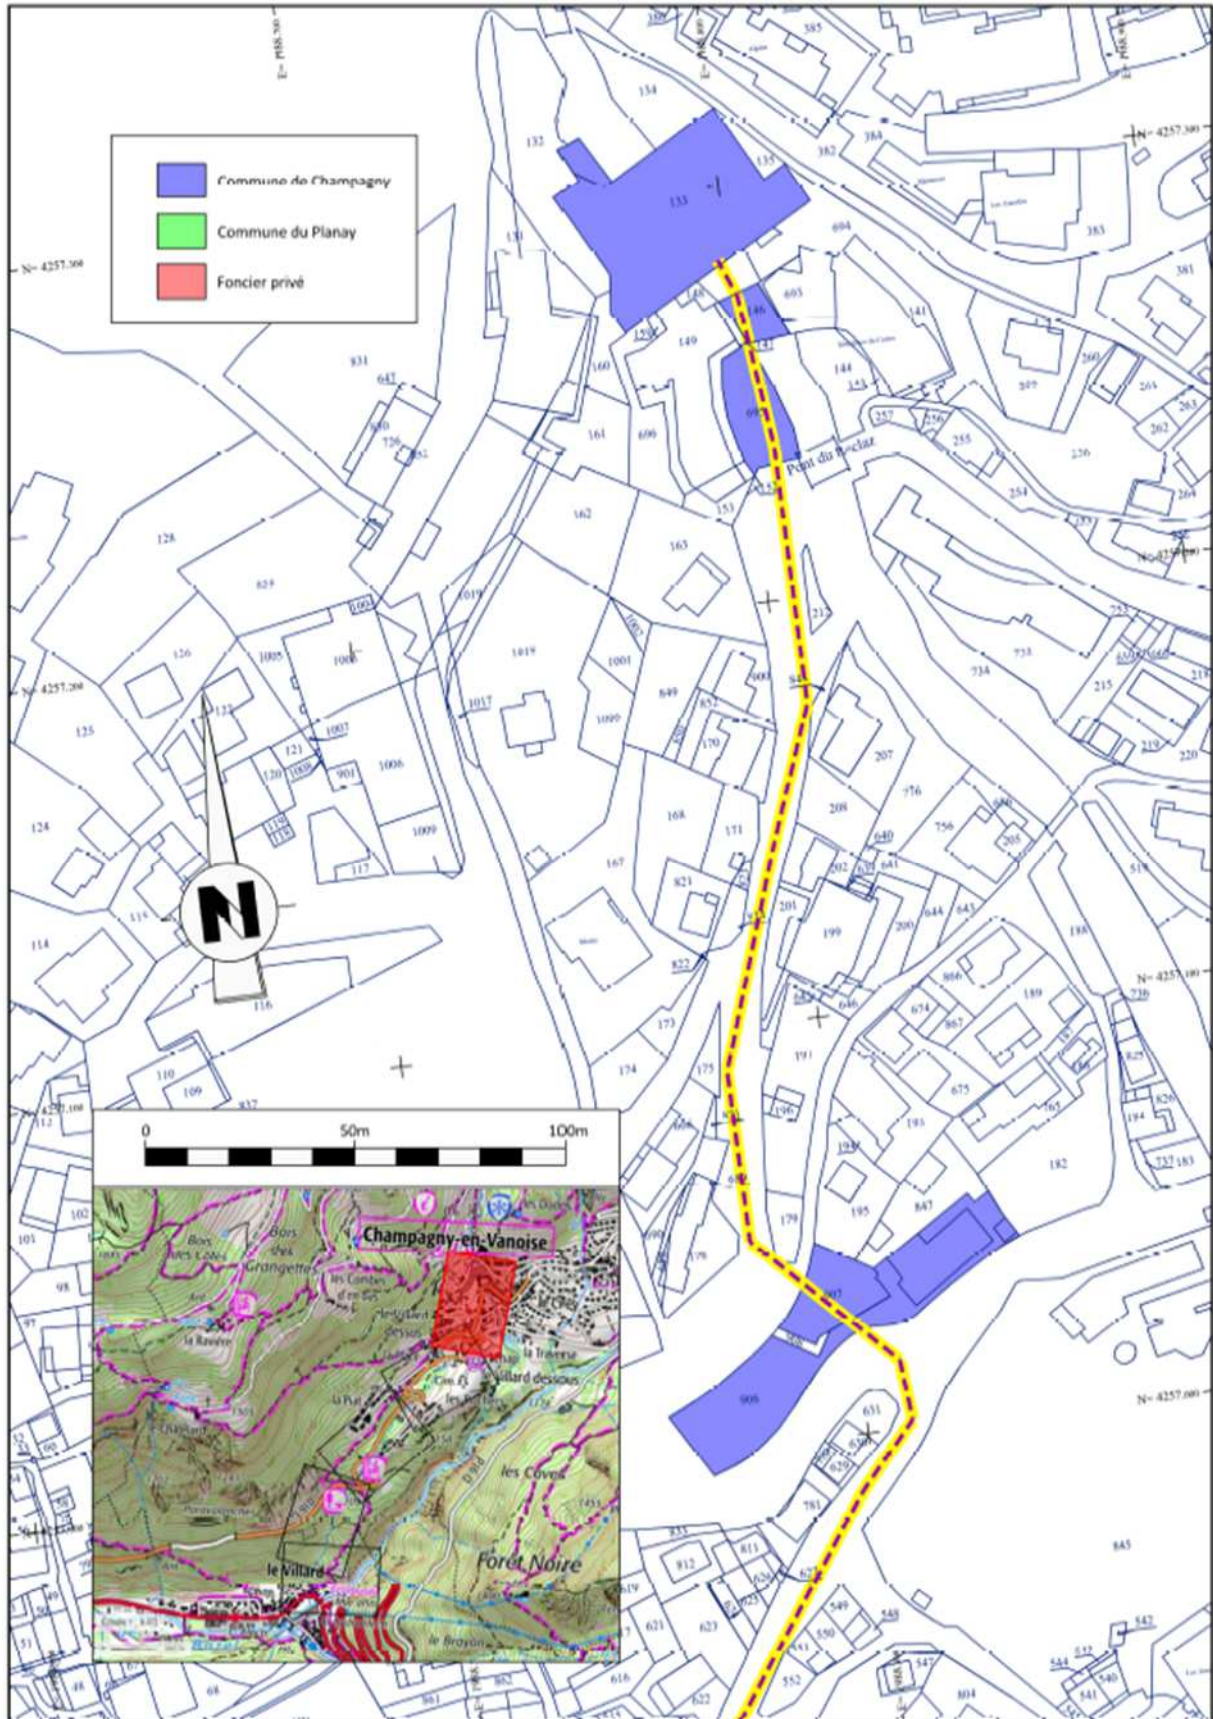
Implantation des ouvrages sur fond de plan cadastral - planche 1/5
